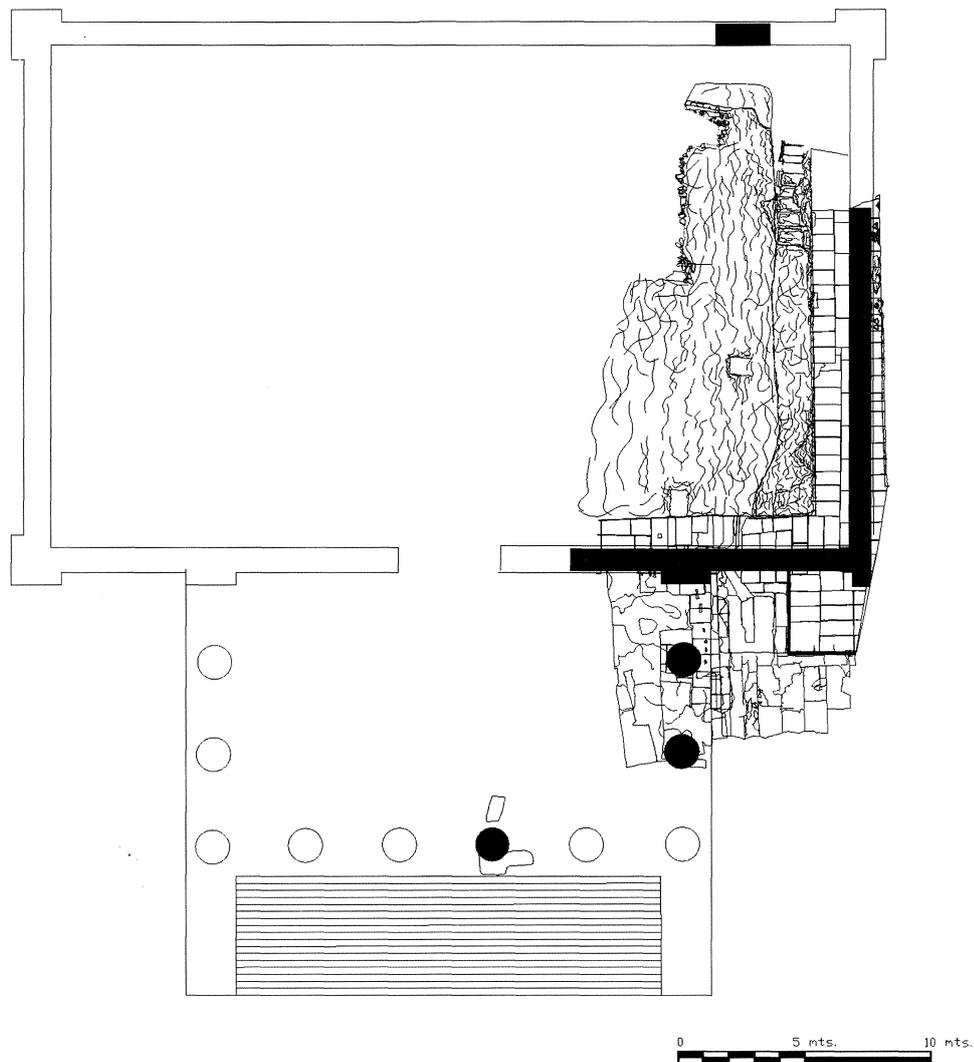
Reconstrucción de la planta del templo de culto imperial. Escala 1/300.
